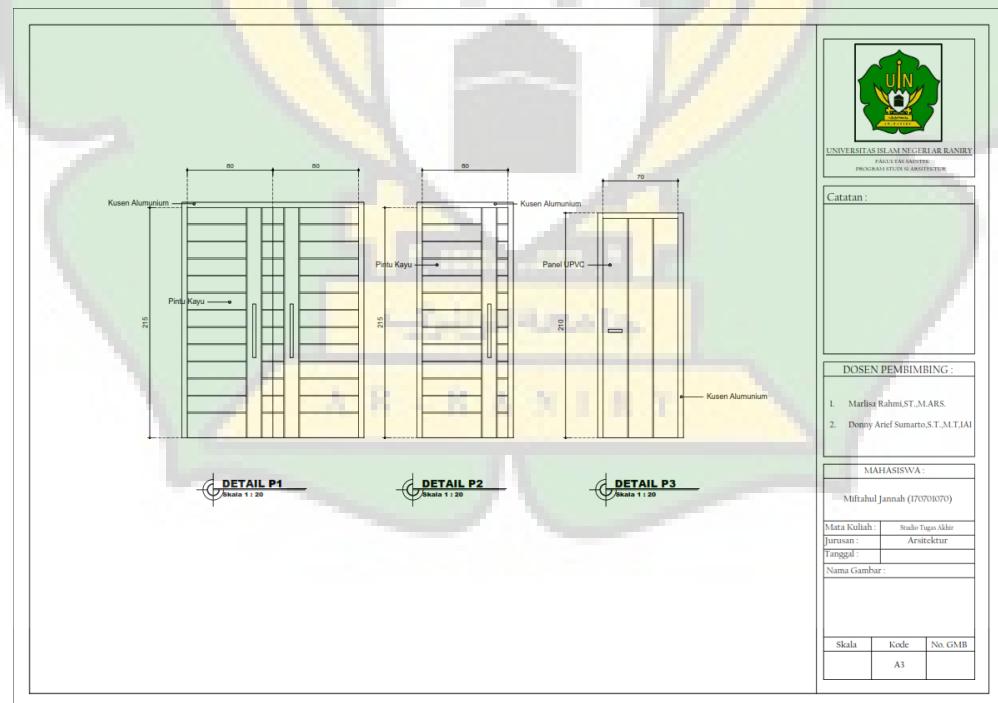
Denah Rencana Kusen Lantai 1
